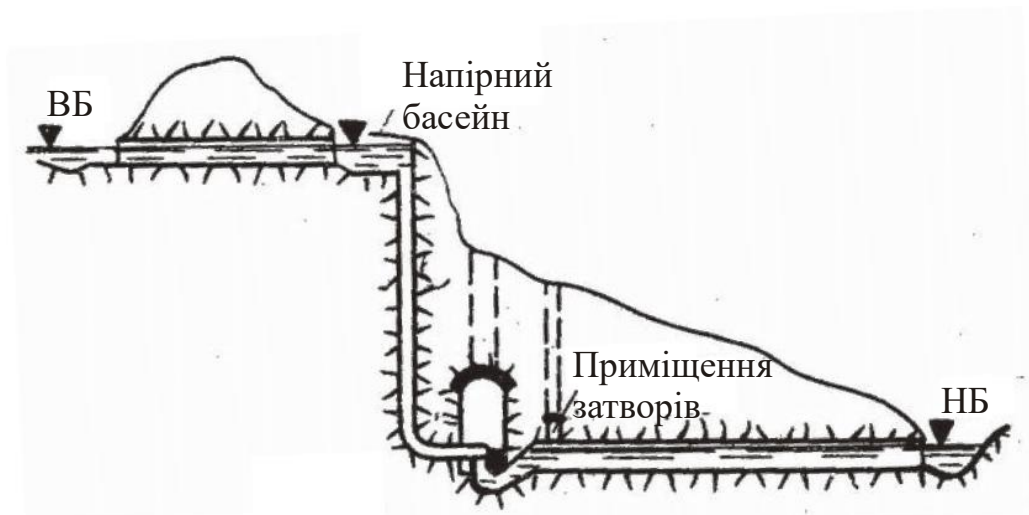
Проміжна схема з безнапірною деривацією
